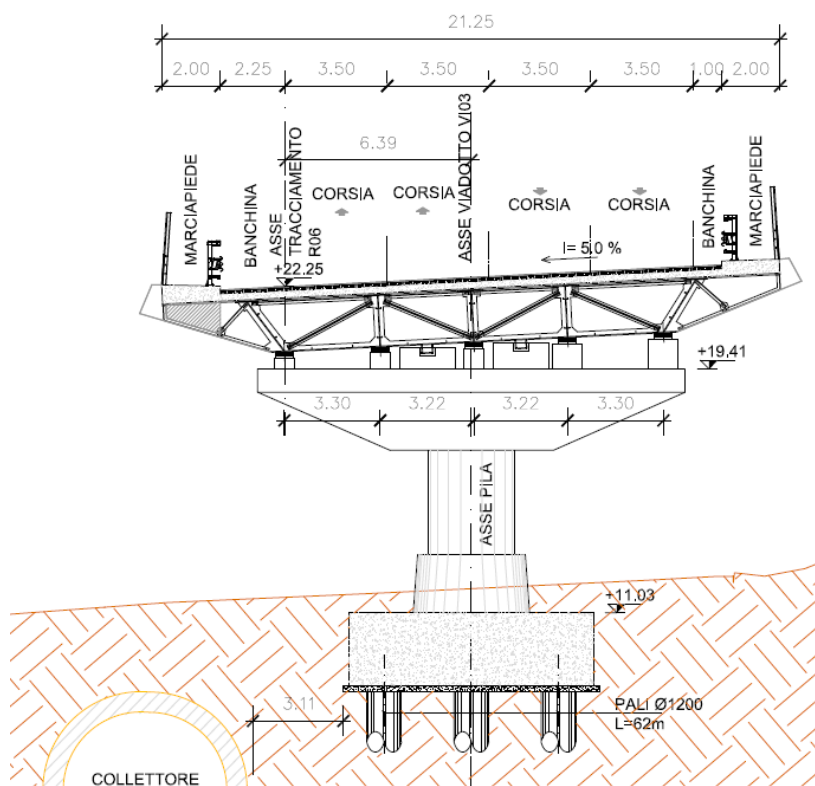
Viadotto VI03 - Sezione trasversale su pila
